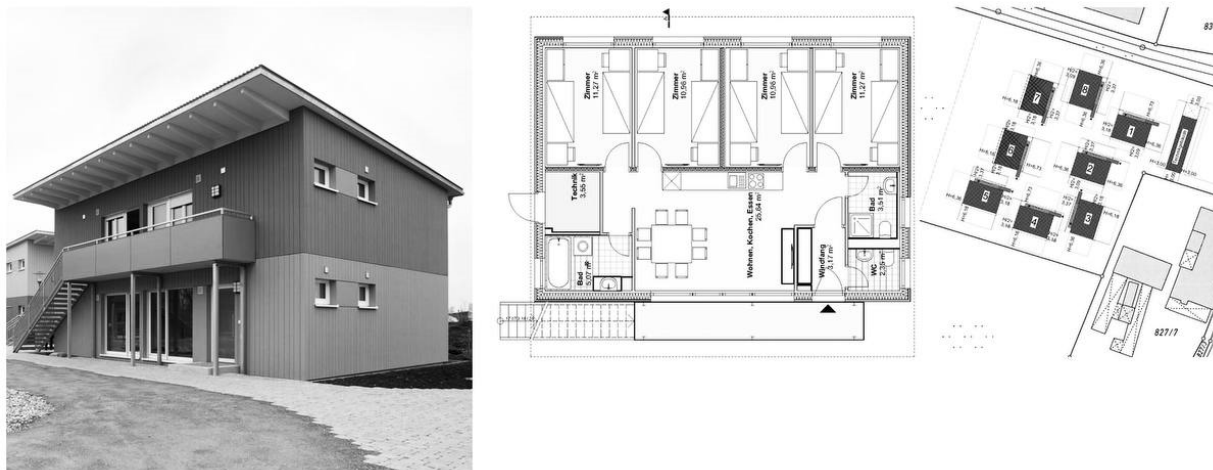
Генеральний план та фото фасадів модульного містечка в Кенігсбрунні, Німеччина
